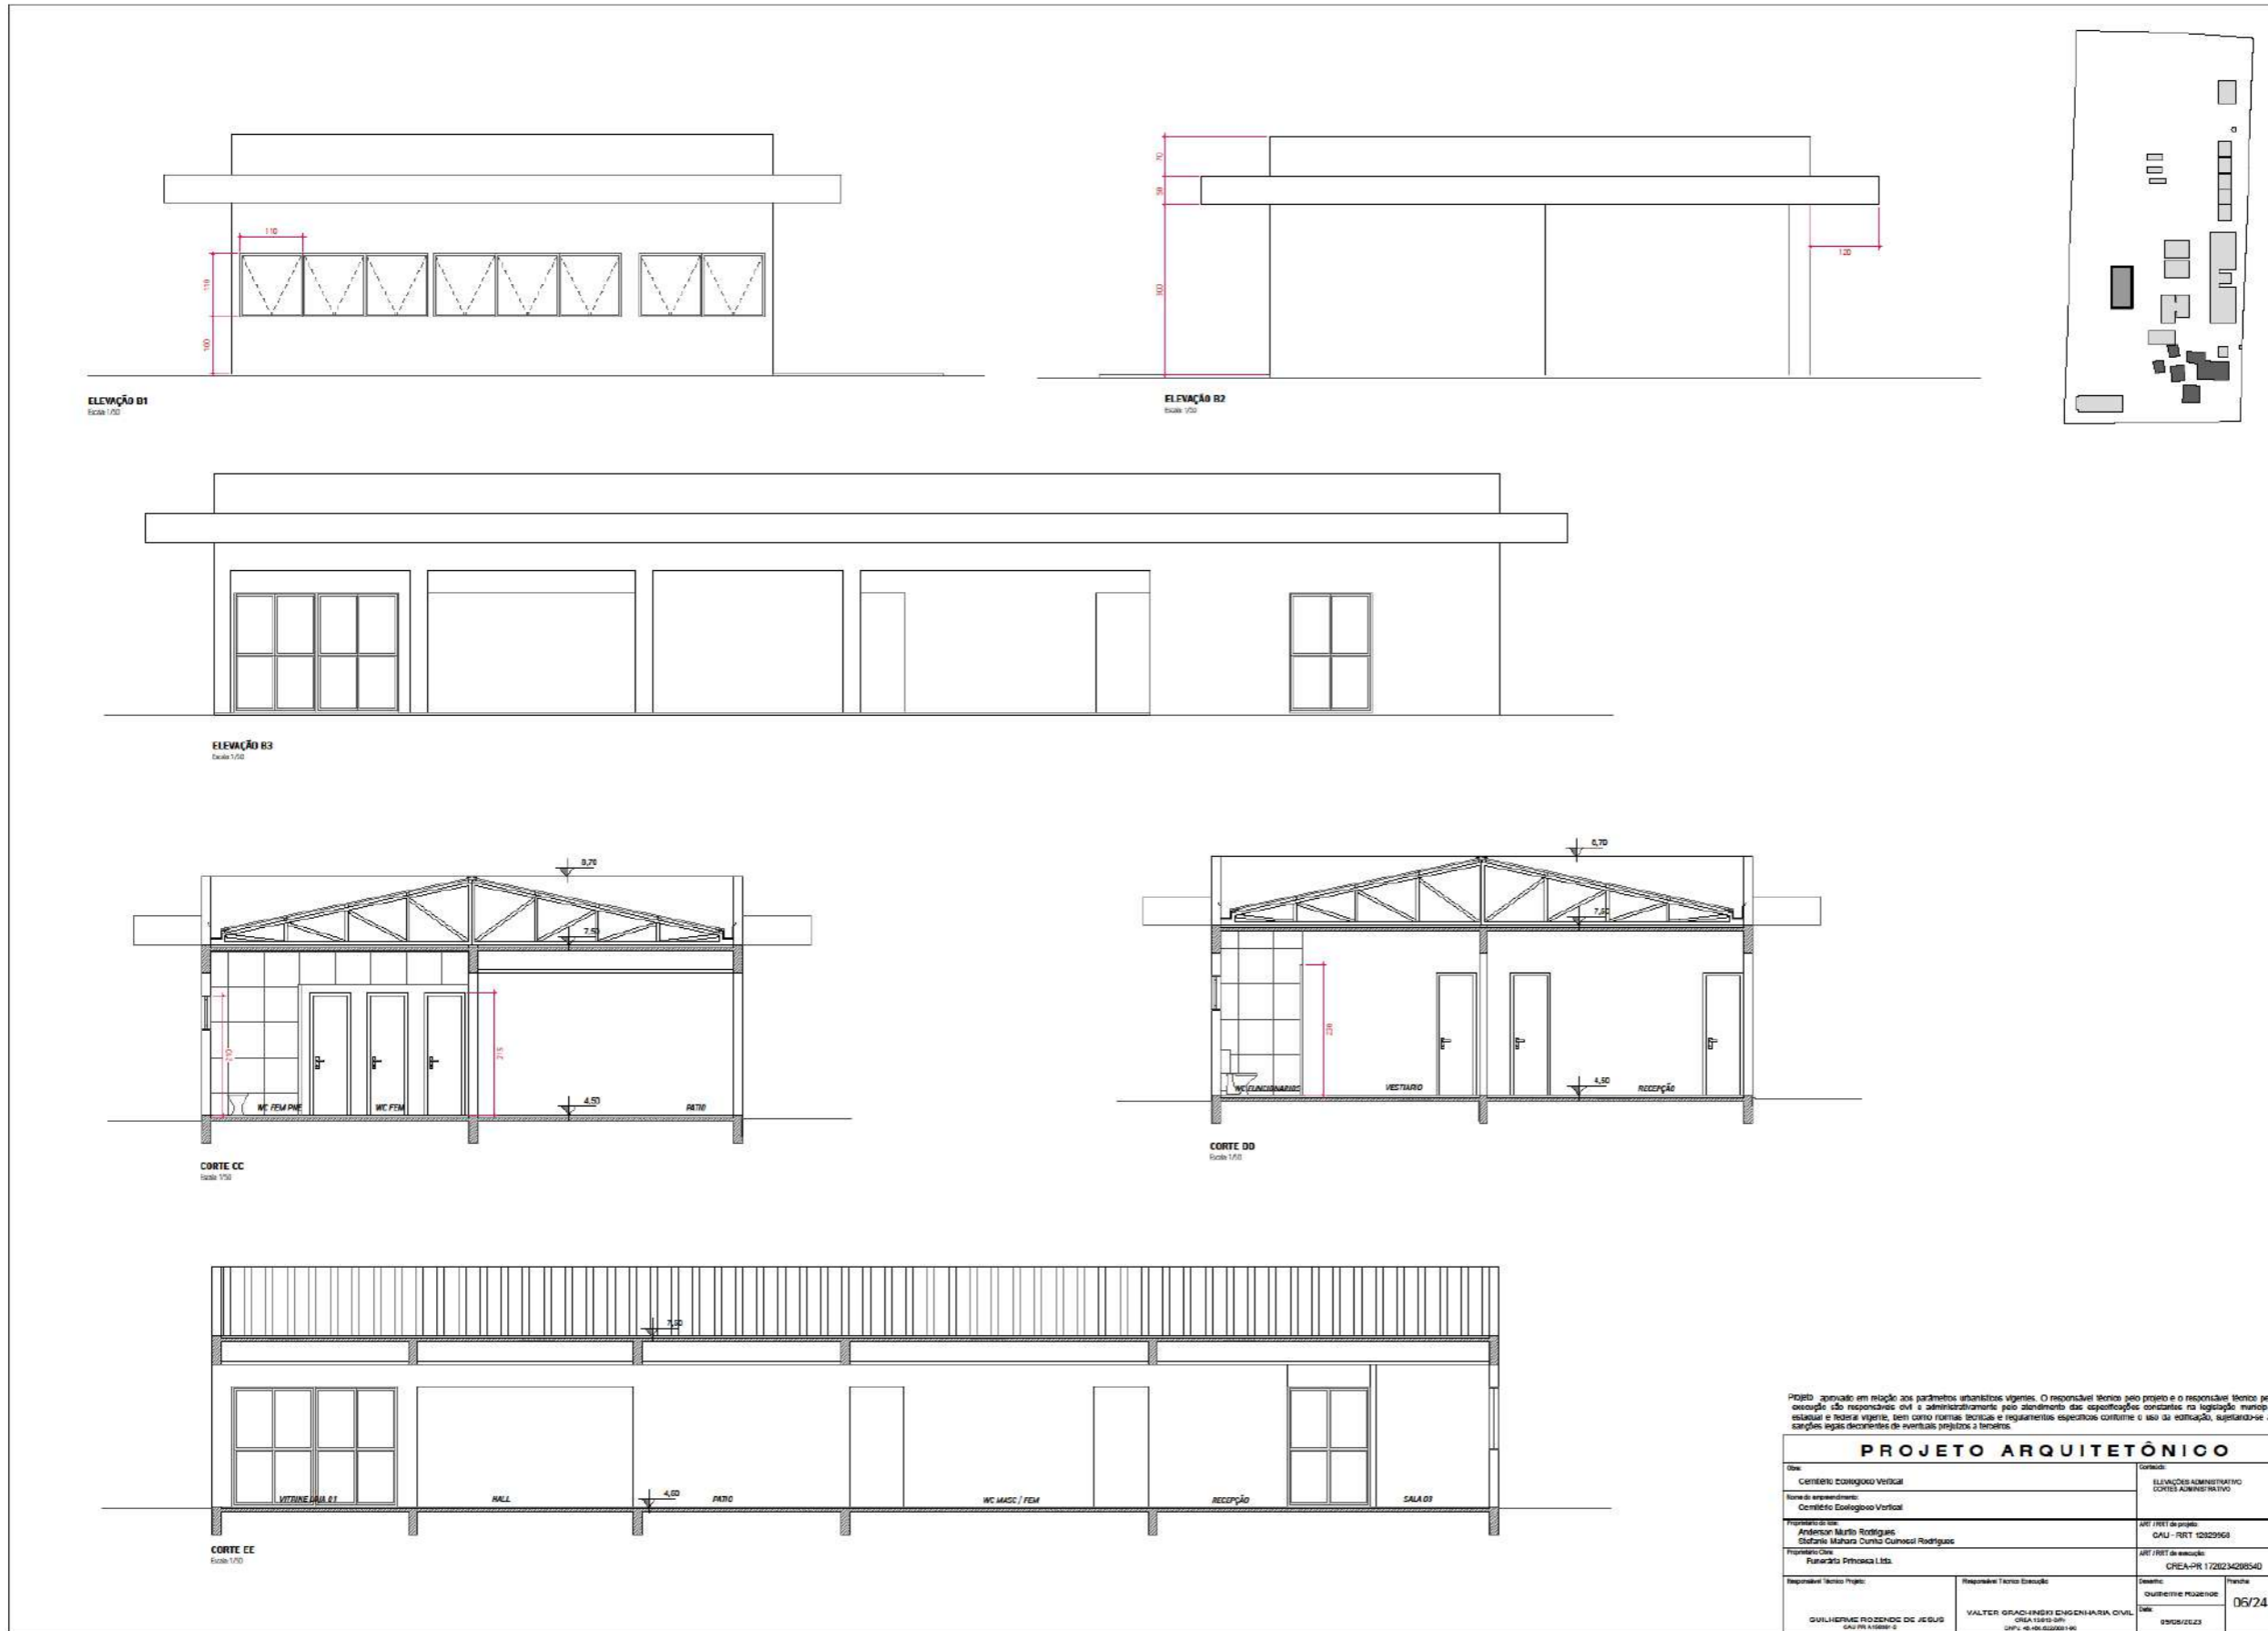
Projeto Arquitetônico – Prancha 04-24.
